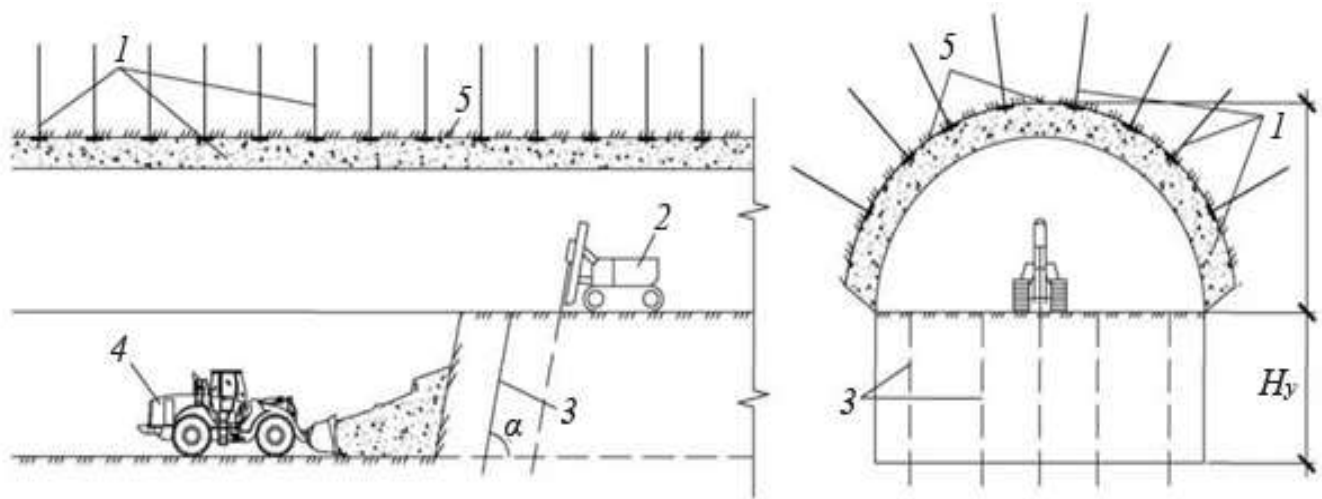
Буріння круто нахилених свердловин верстатом на уступі:
